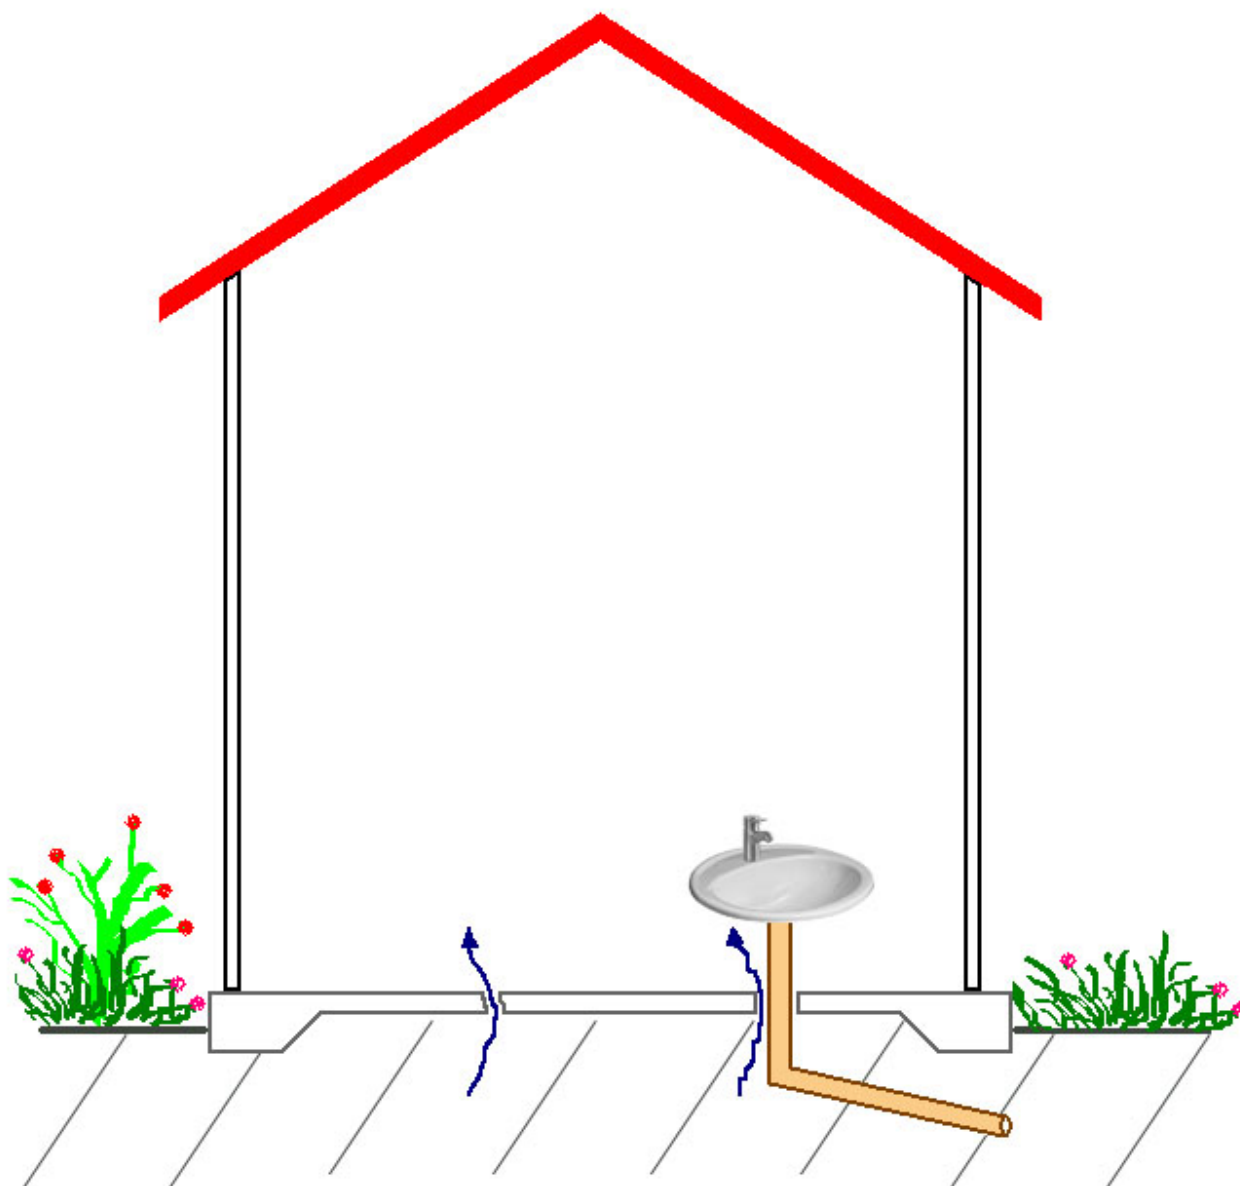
Здание на монолитной бетонной плите. Насыщенный радоном грунтовый воздух проникает в помещения через отверстия и трещины в плите
